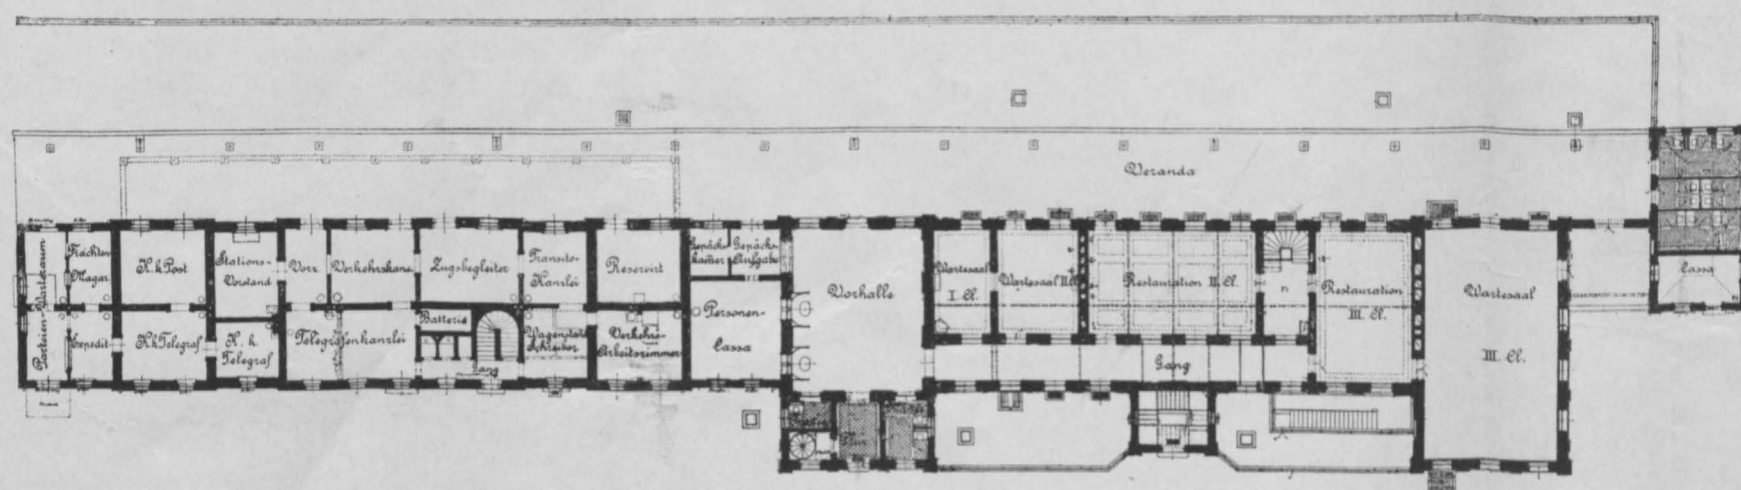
Grundriss des heutigen Aufnahmegebäudes. 1:500. (Den linken Theil bildet das adaptirte alte Gebäude, den rechten Theil der neue Zubau.)
